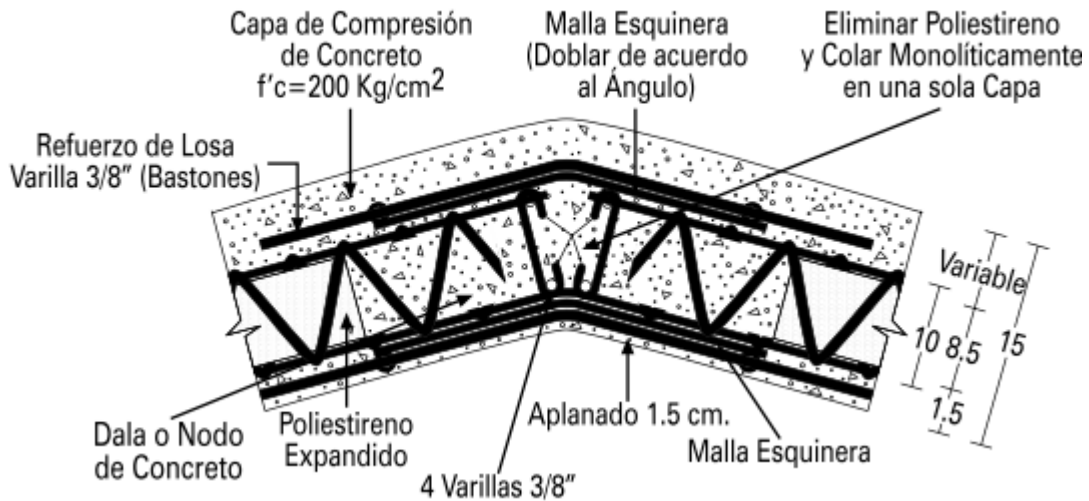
Unión de losa en dos aguas, trabe integrada (Corte).
